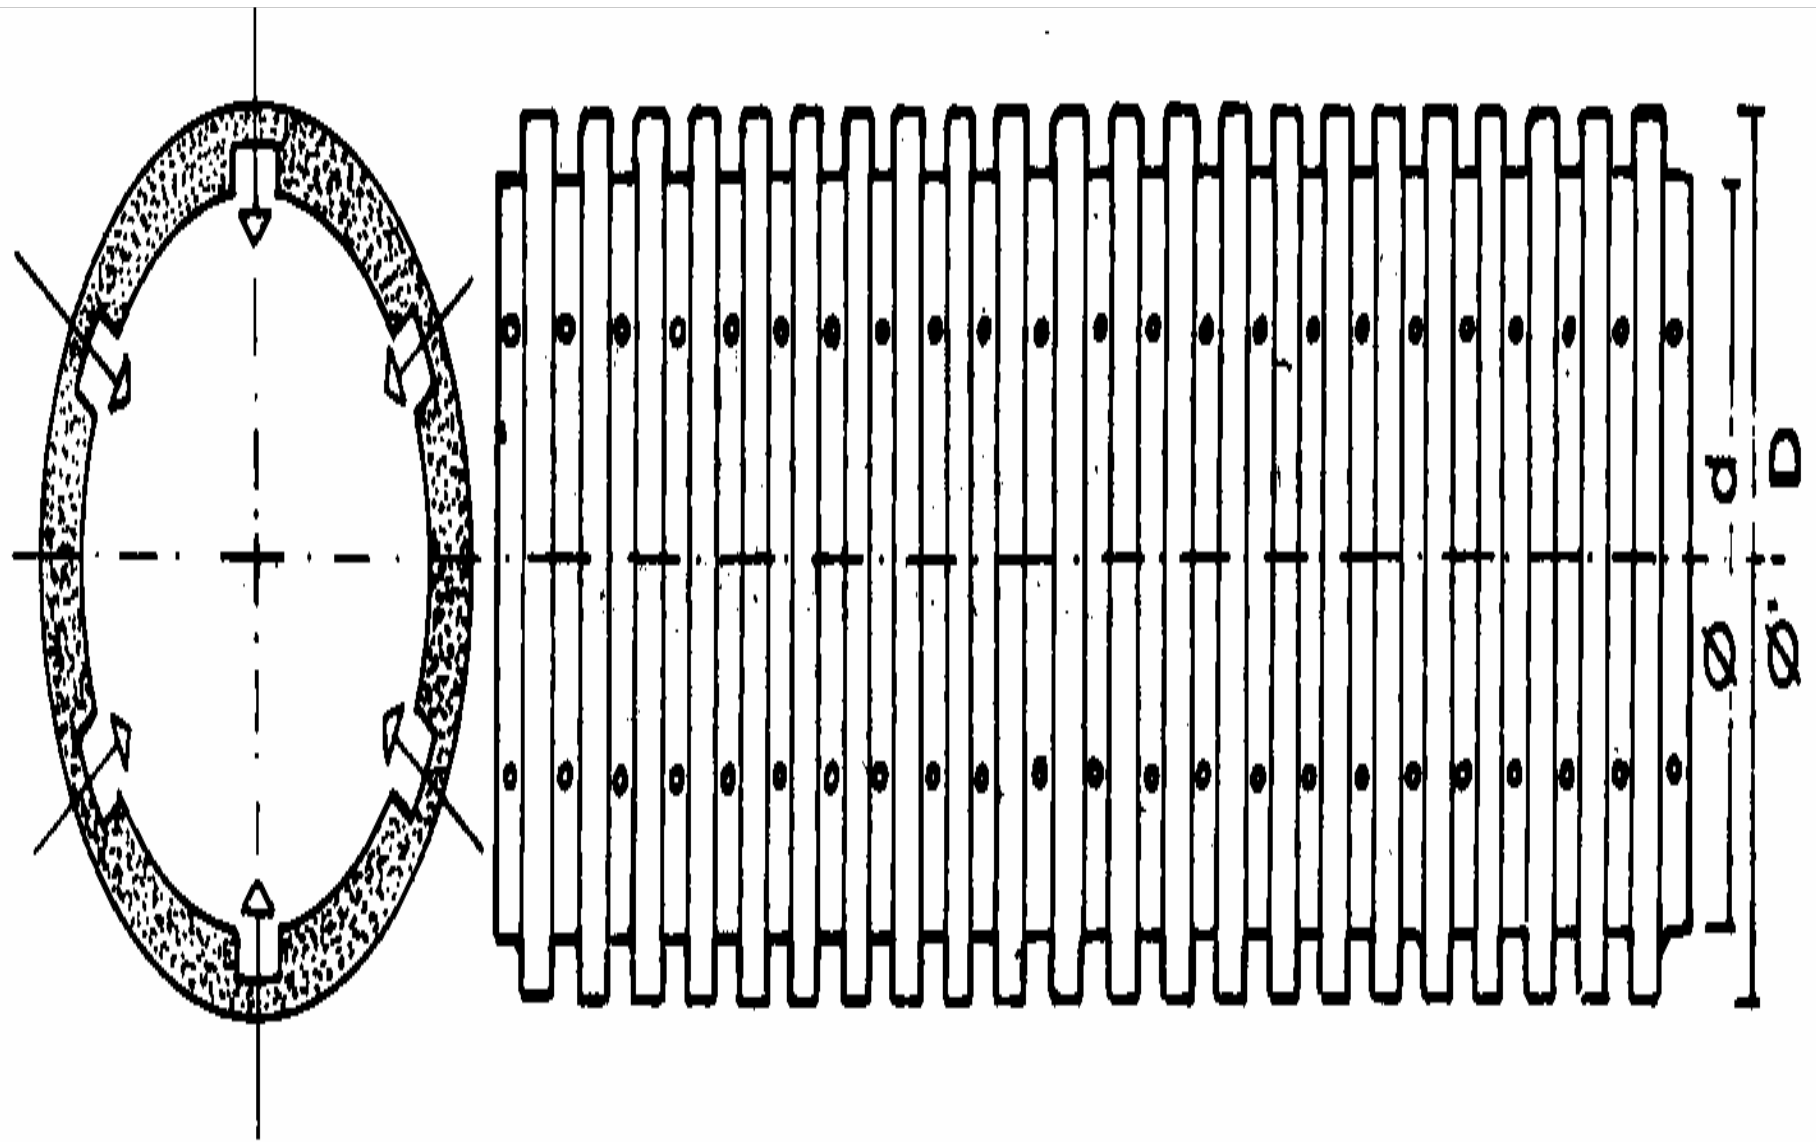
Tubo para drenaje de PVC, ondulado y sección circular, tipo Glassi-Dren
